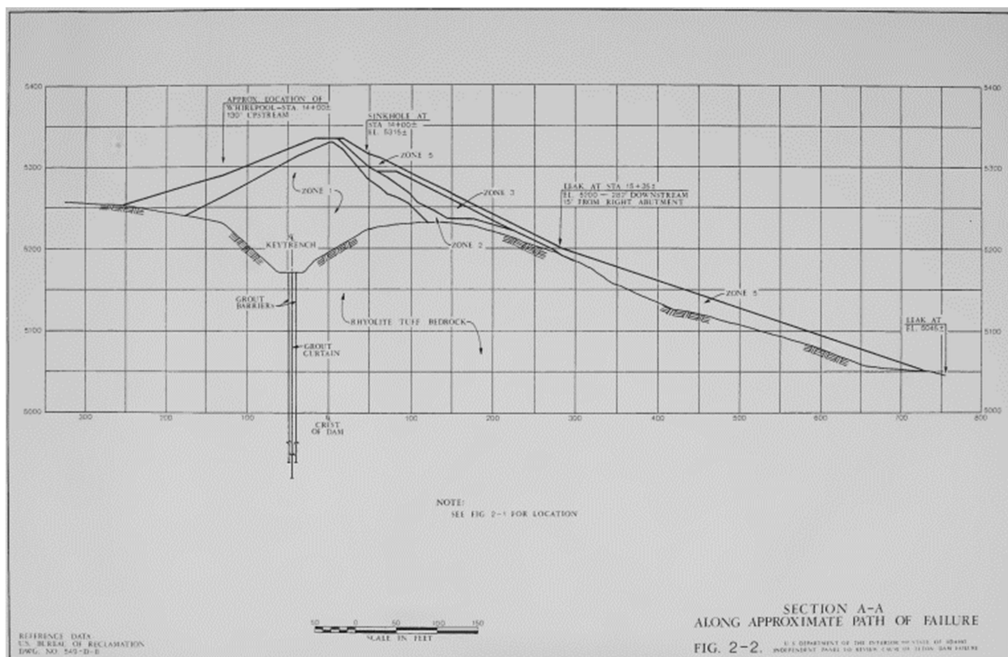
Secțiunea transversală a barajului Teton, aproximativ în zona cedării inițiale.
